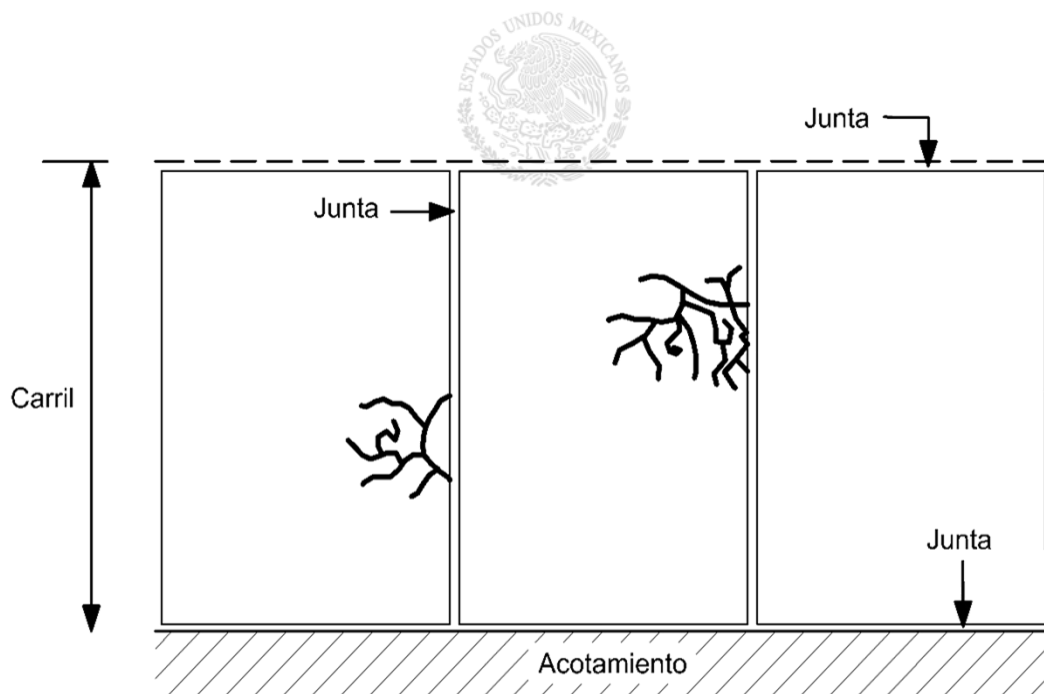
Esquema del deterioro “escamado” (vista en planta)
